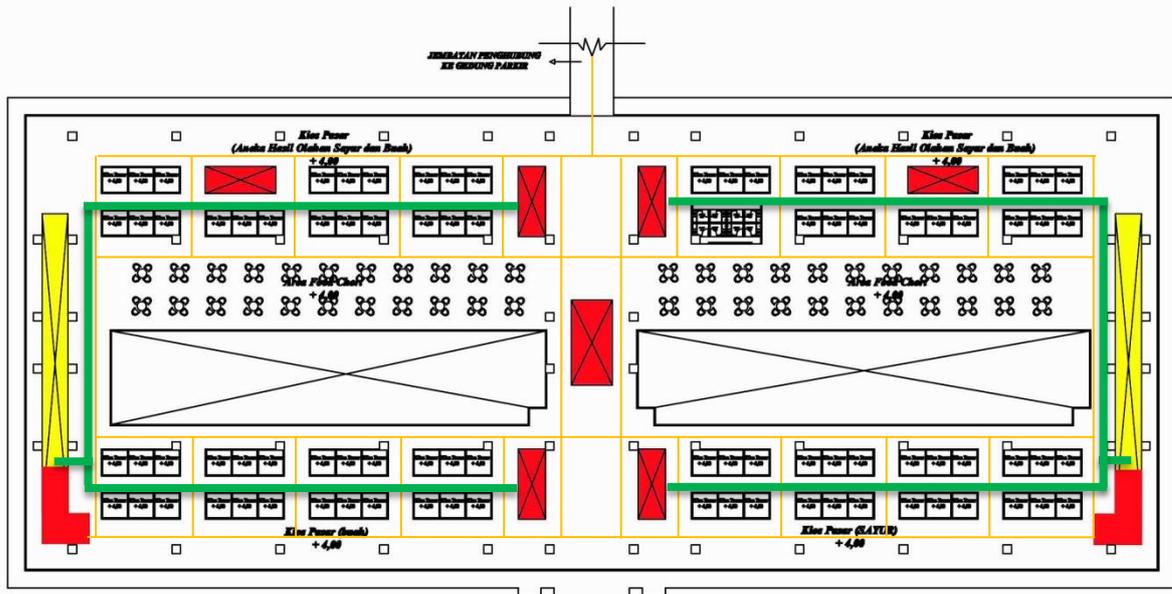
Sirkulasi Bangunan Lantai 1
